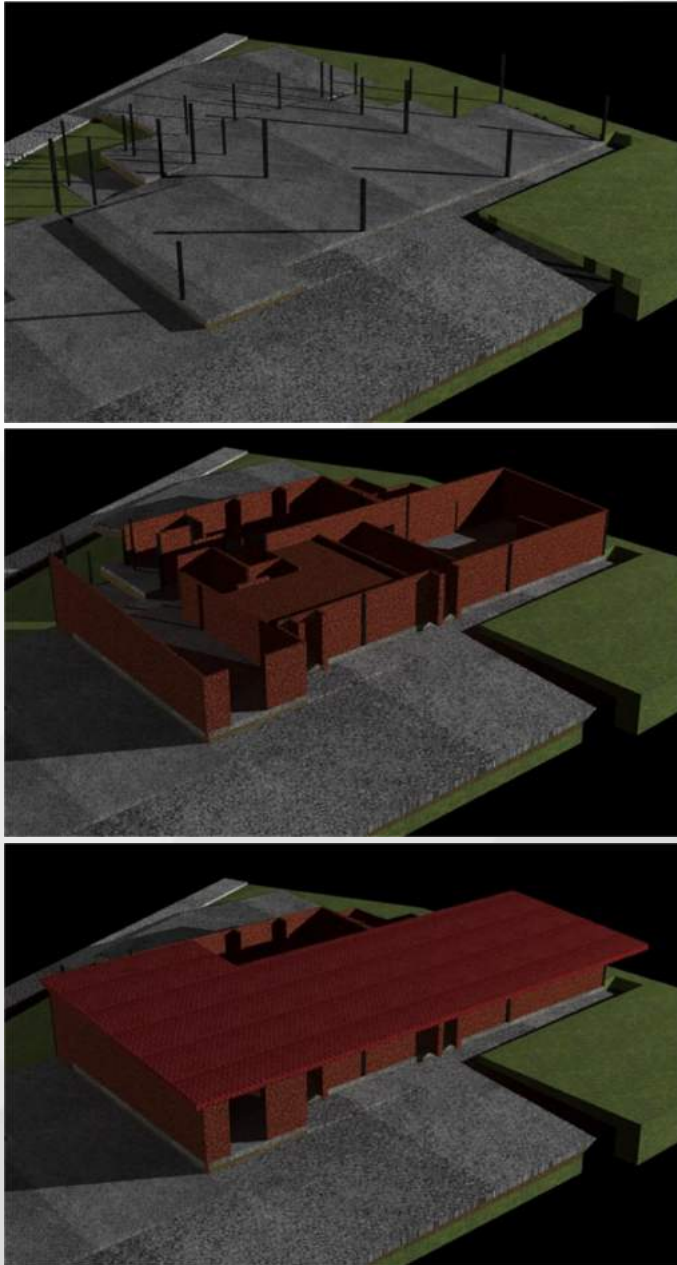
Modelo de elementos estructurales del proyecto: columnas, muros y tridilosa
